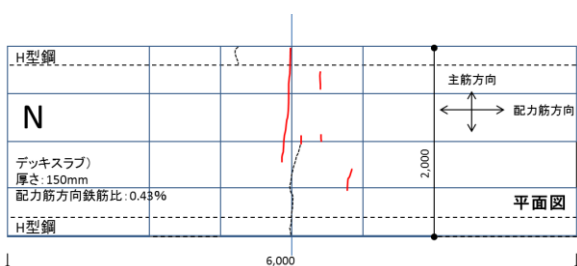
デッキスラブ試験体ひび割れ発生状況
